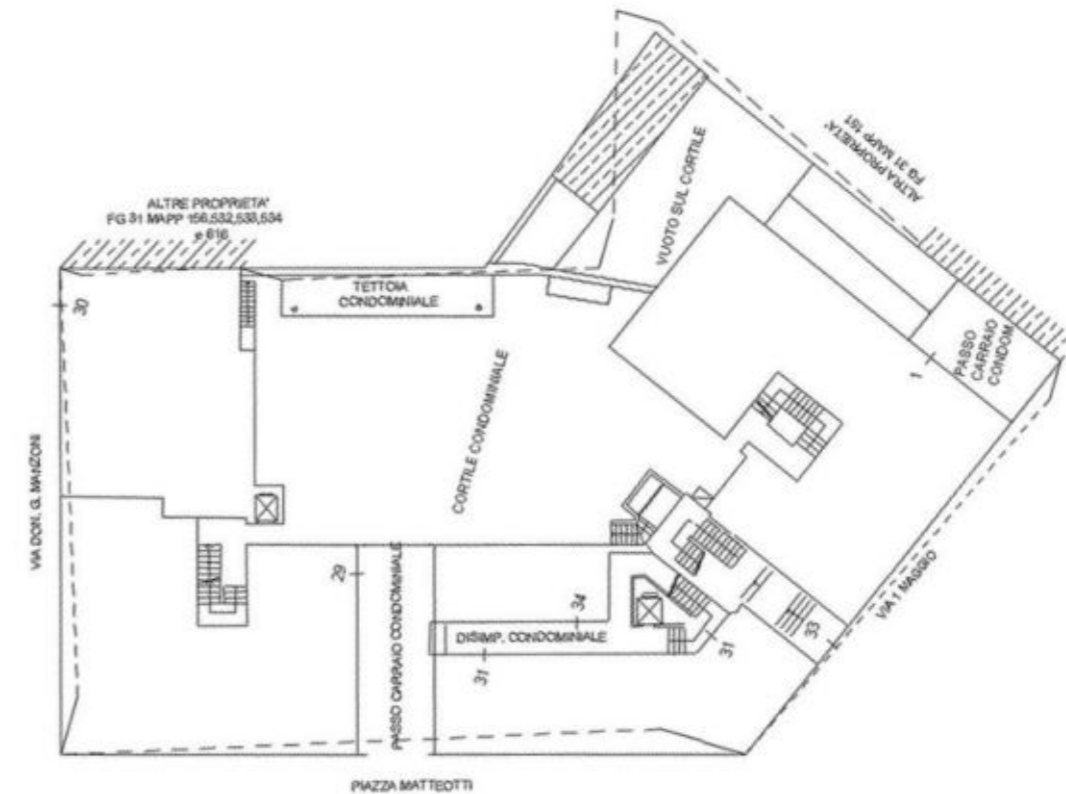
Estratto dal catasto – stralcio dell'elaborato planimetrico relativo al piano terra dello stabile
